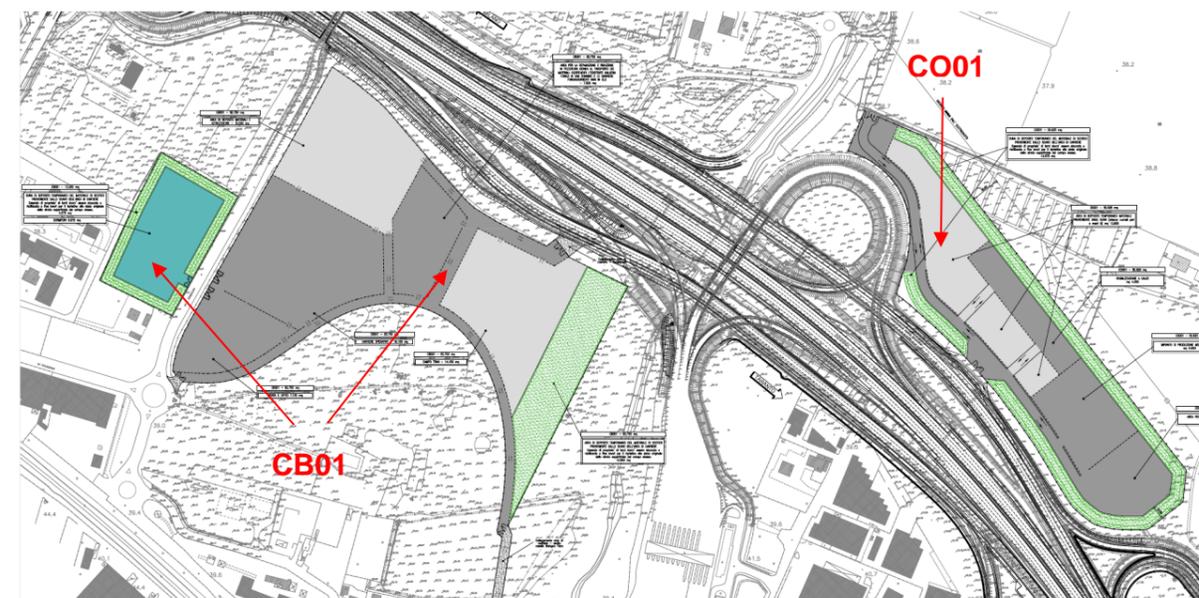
area di cantiere CB01 (estratto tav. CAP300-0)
